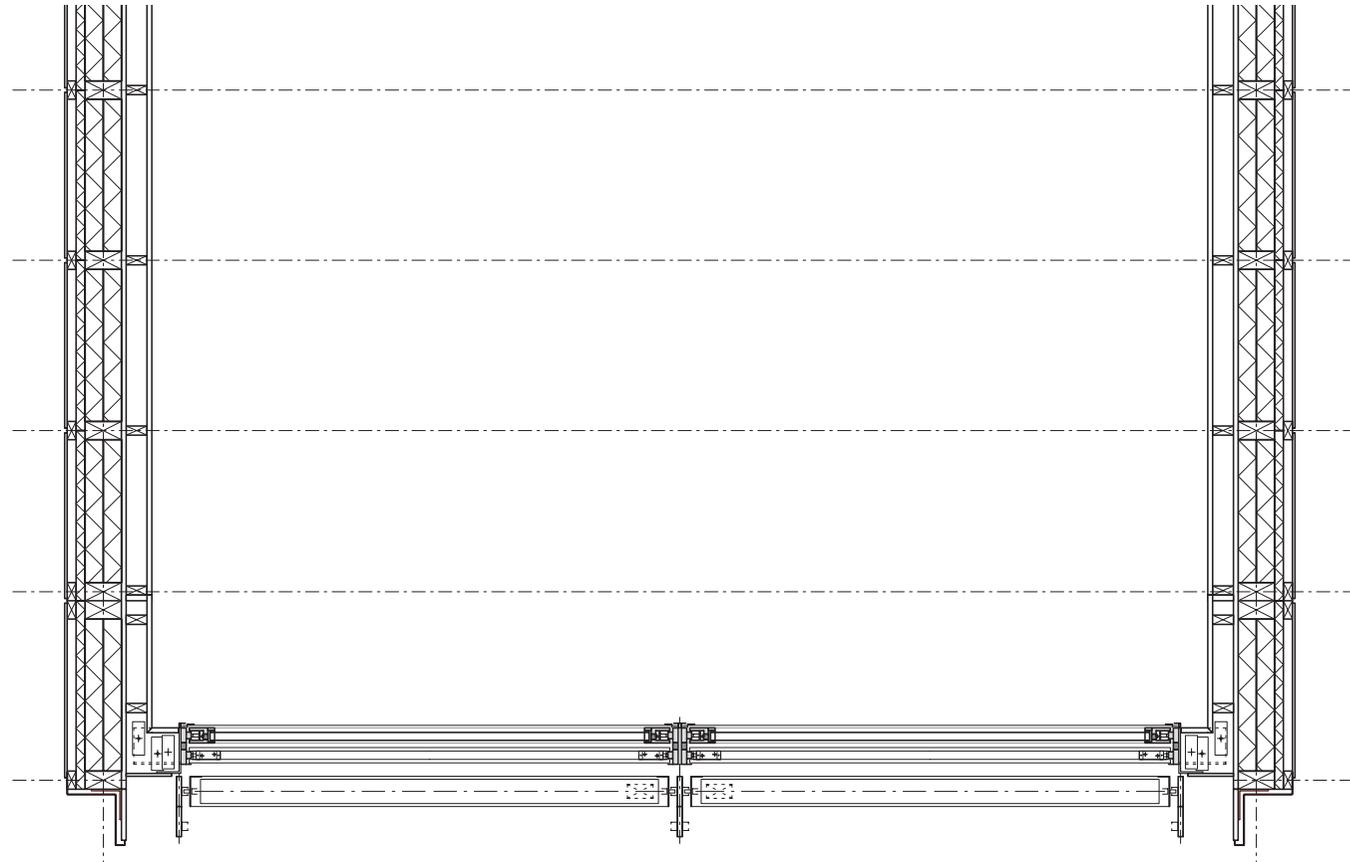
Grundriß Meßbox, M. 1:25 Horizontalschnitt auf Höhe des mittleren Fensters
